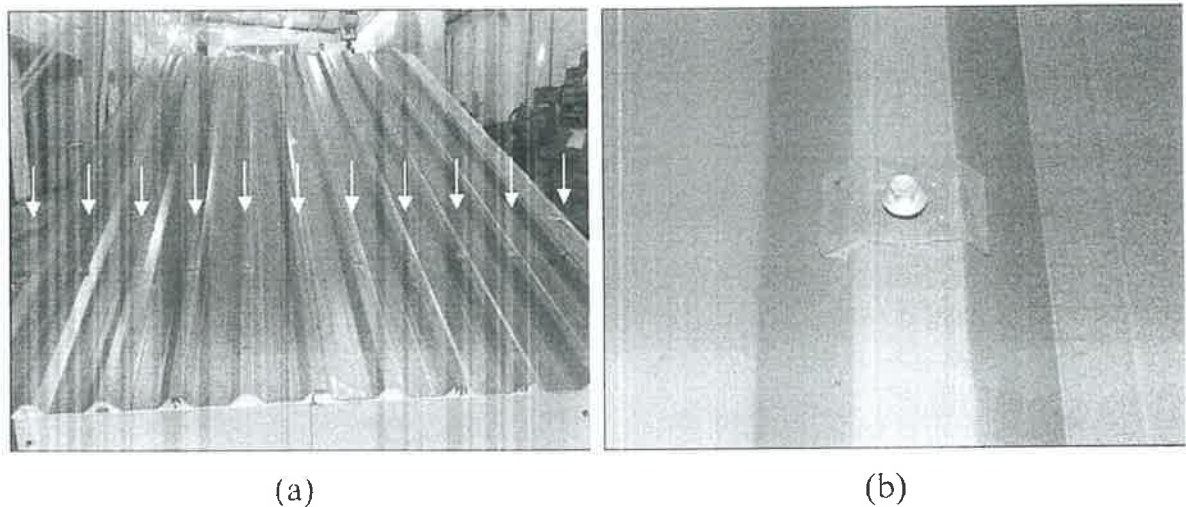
(a) Vista geral do protótipo da cobertura; (b) Detalhe da fixação das telhas.
